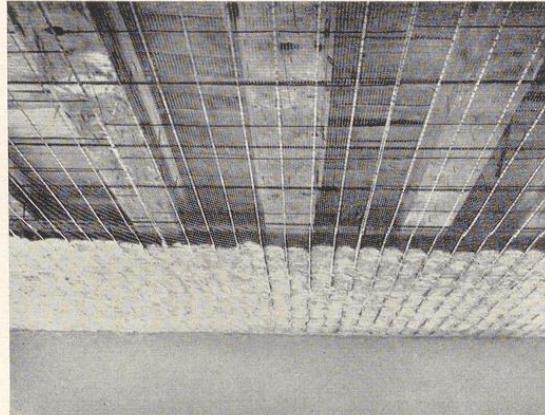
Rabitzdecke mit Baustahlmatten unter Holzgebälk, teilweise mit Gipshaarkalkmörtel ausgedrückt
